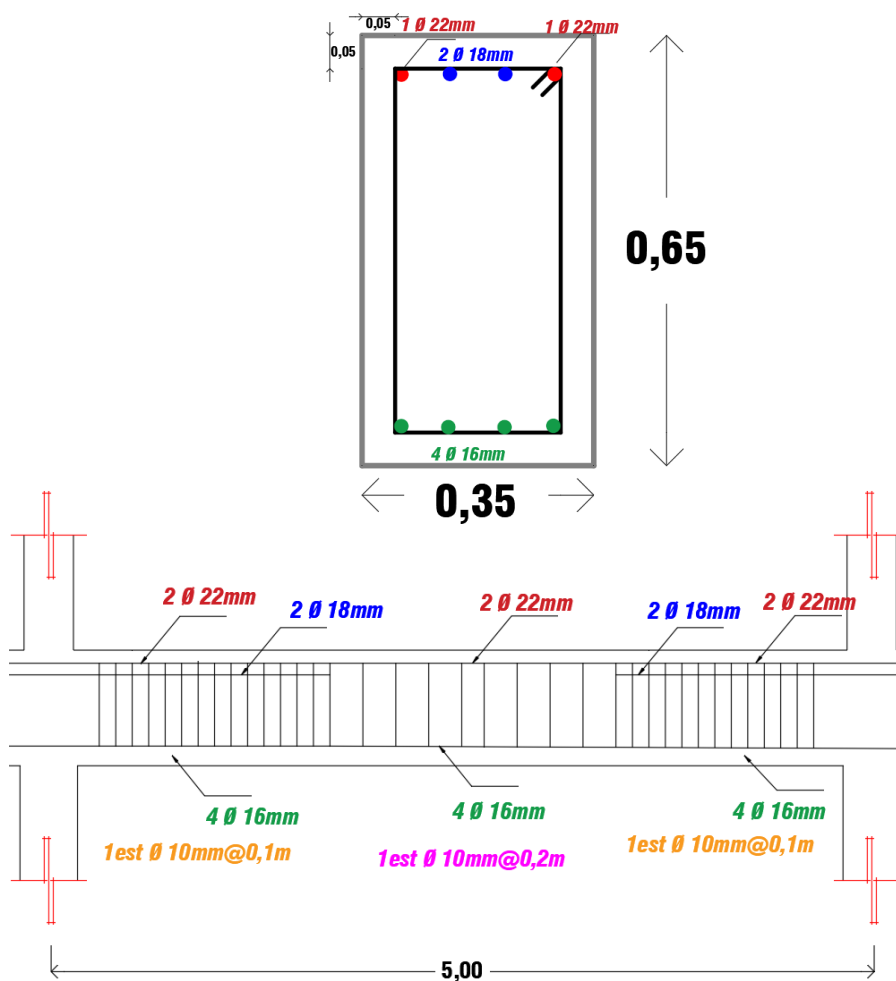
Detalle de la sección de acero de la viga crítica del sistema R=8
